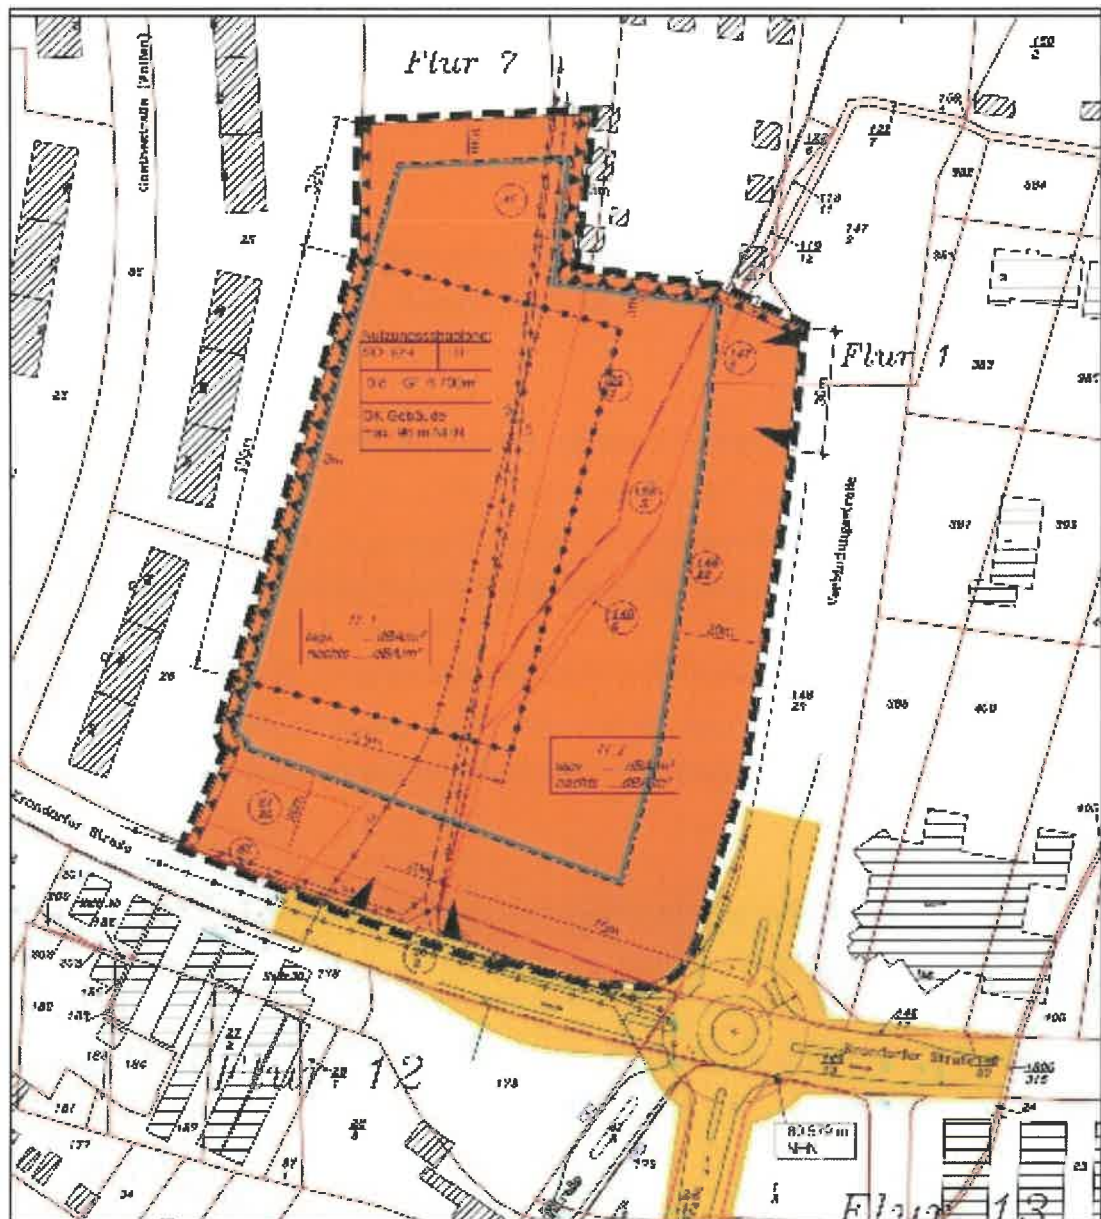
Plangebiet Bebauungsplan 'Warenhaus Krondorfer Kreisel' – kein amtlicher Maßstab.
